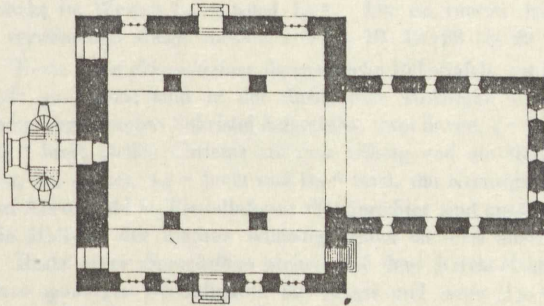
Bahn; Kirche, Grundriss nach 1854.
